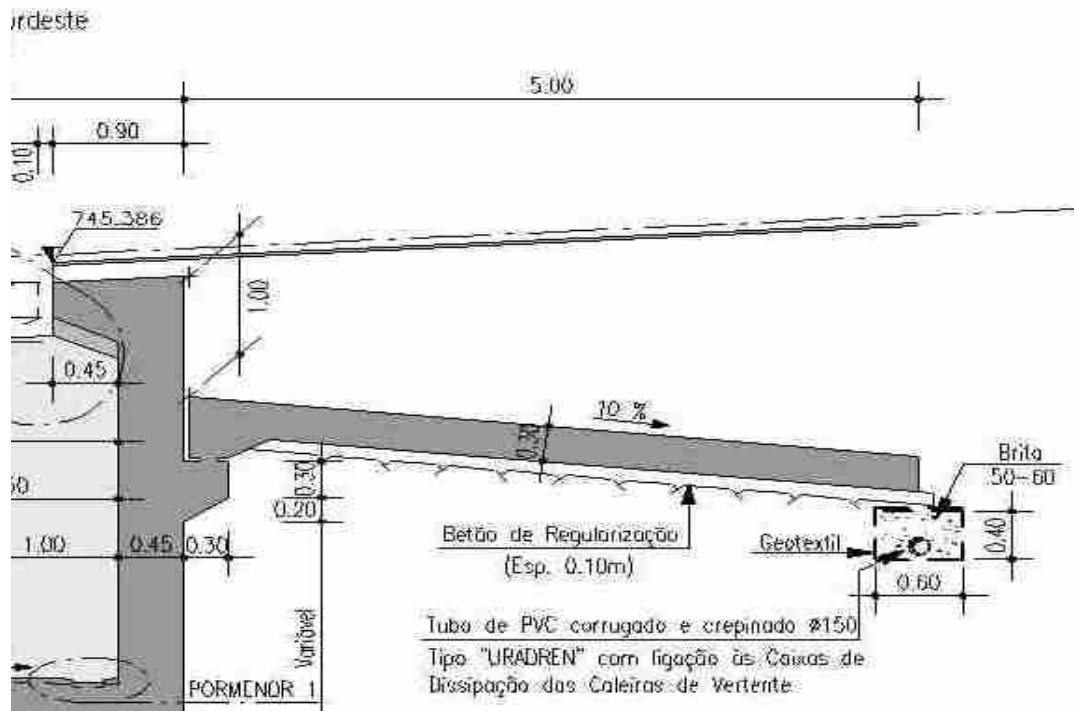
Pormenor da laje de transição da Ponte sobre o Rio Azibo.
